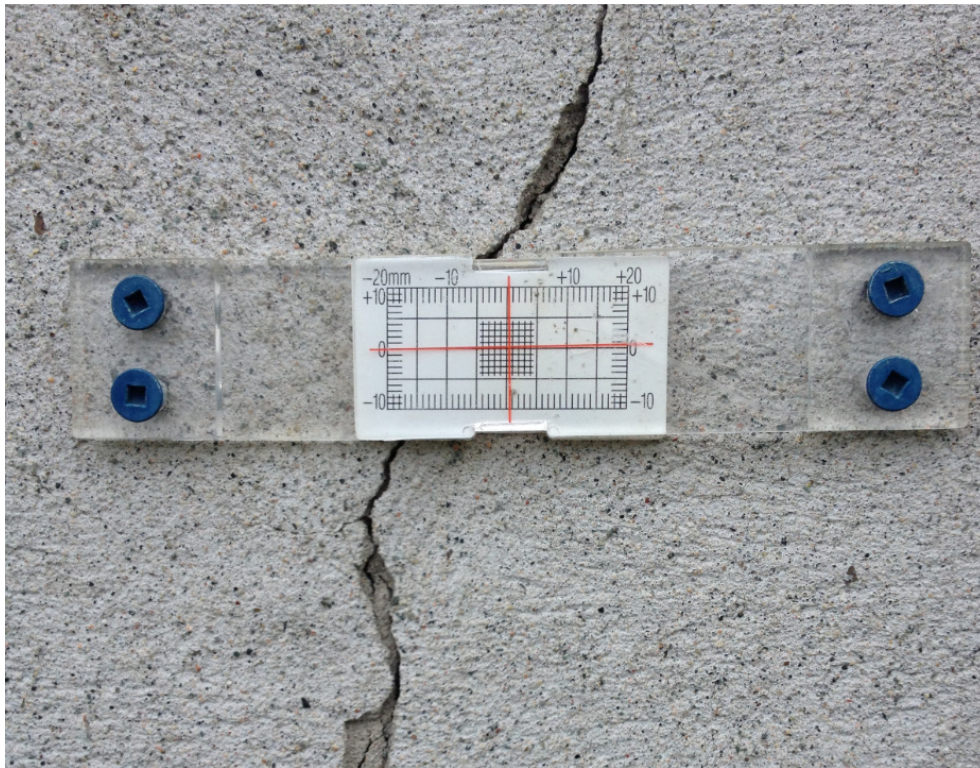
Fissuromètre installé sur le mur d'un bâtiment dans la ville de Malartic
